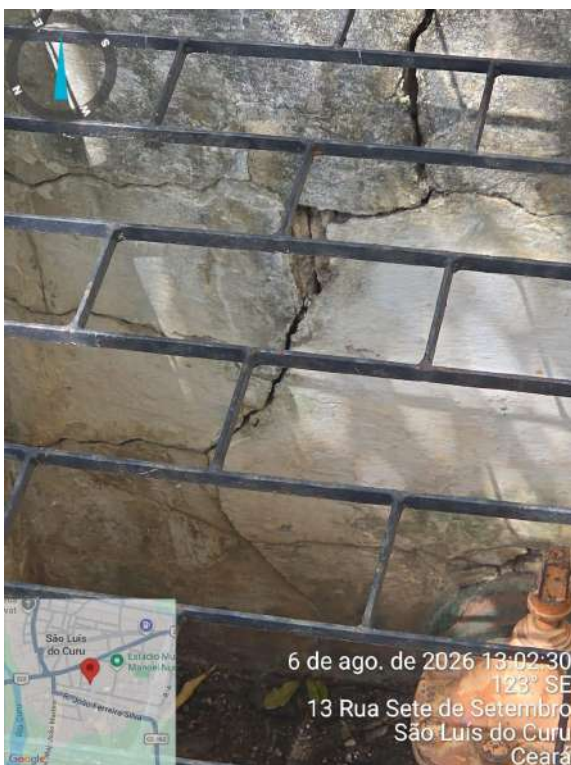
Adutora da ETA: paredes da caixa de passagem com fissuras e sinais de deterioração do revestimento, além da ausência de dispositivo manual de acionamento do registro (volante/manivela).
